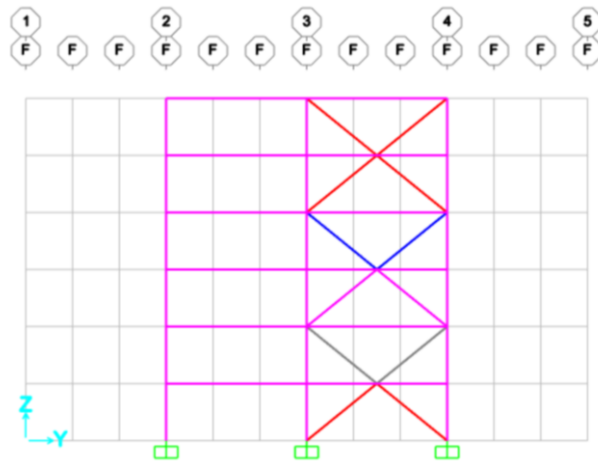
Vista en Elevación del Edificio para la Línea de Columnas 5
